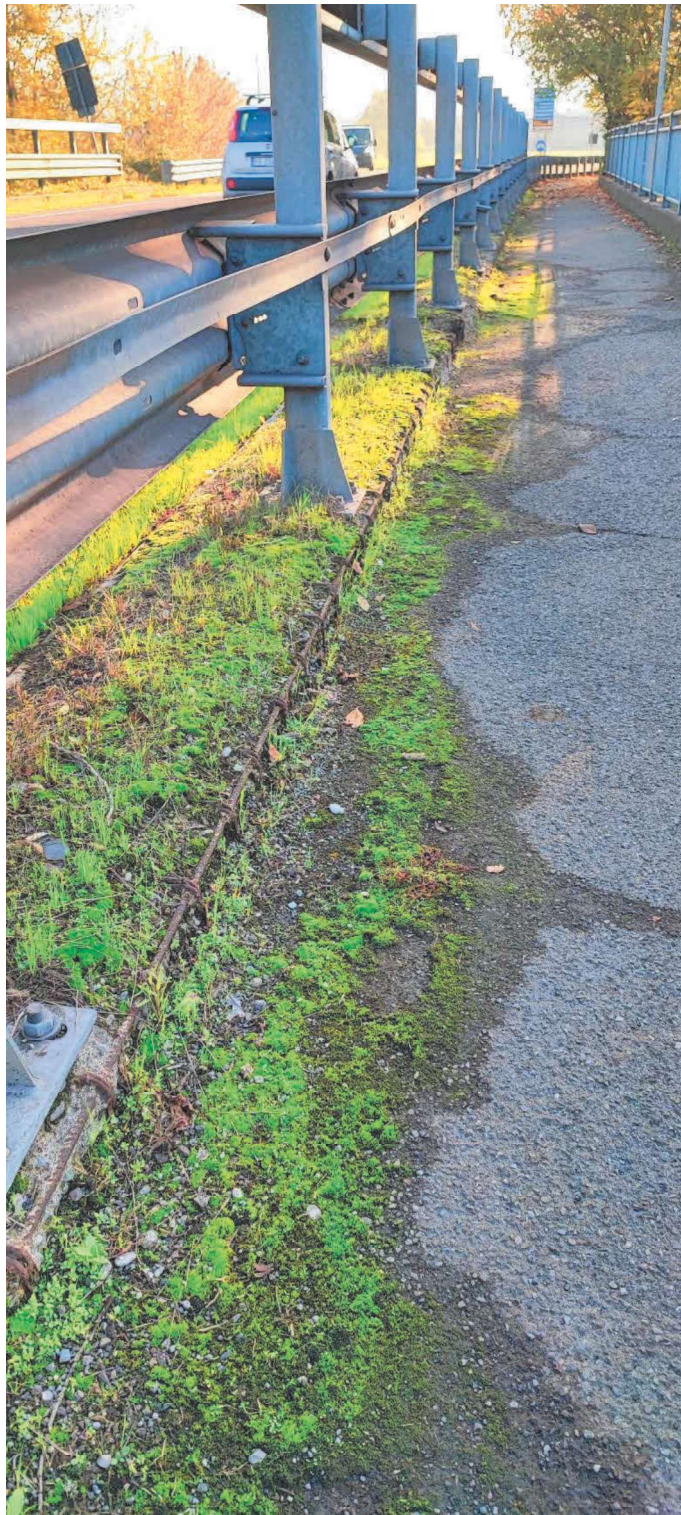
Sede stradale lato Rubiera ammalorato. È previsto il rifacimento dello stesso contestualmente alle lavorazioni di creazione del giunto
